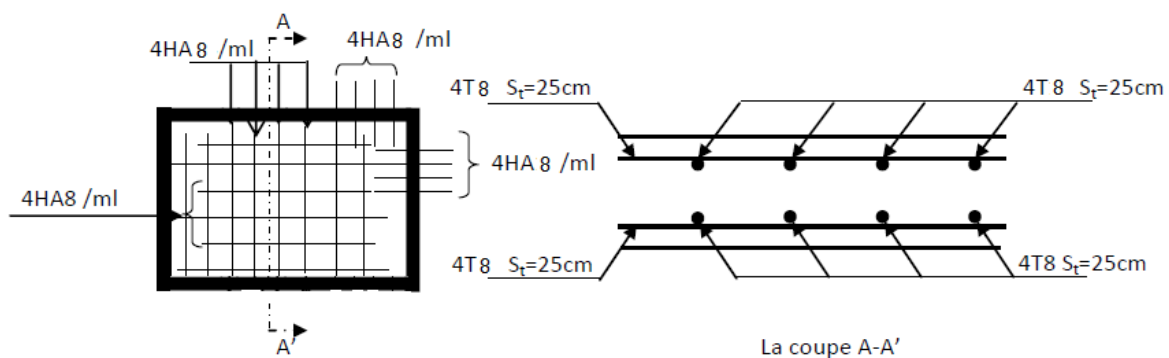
Schéma du ferrailage de la dalle pleine du minaret Pour sous-sol, RDC et 6^{ème} étage
